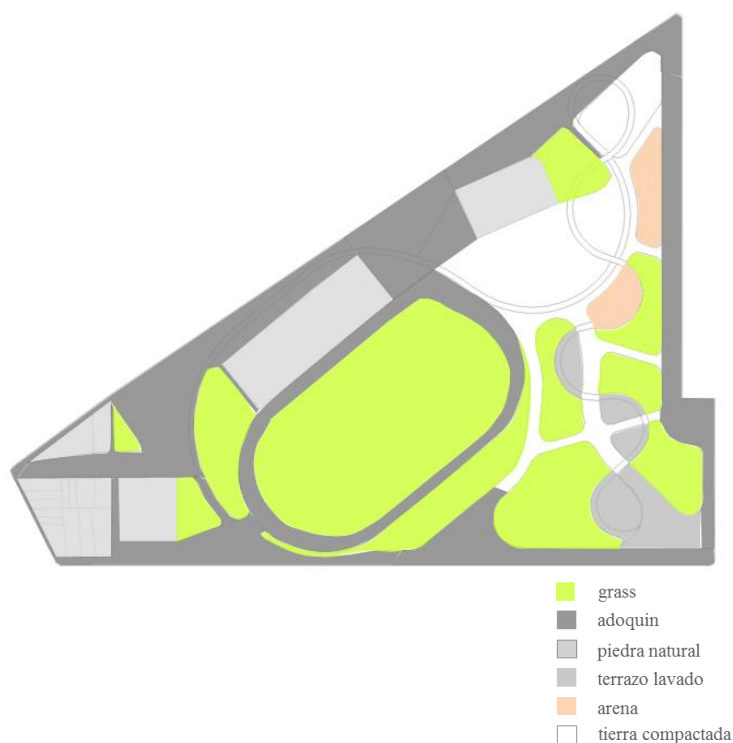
Disposición de pavimentos propuestos en el proyecto.
